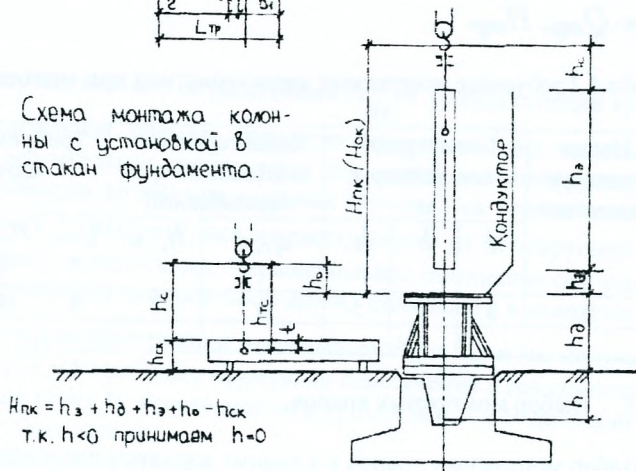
Схема монтажа колонны с установкой в стакан фундамента.
